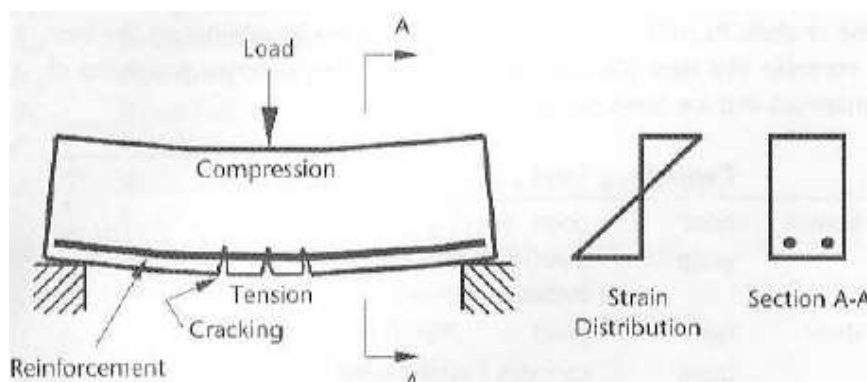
Acción conjunta del hormigón y el acero.
